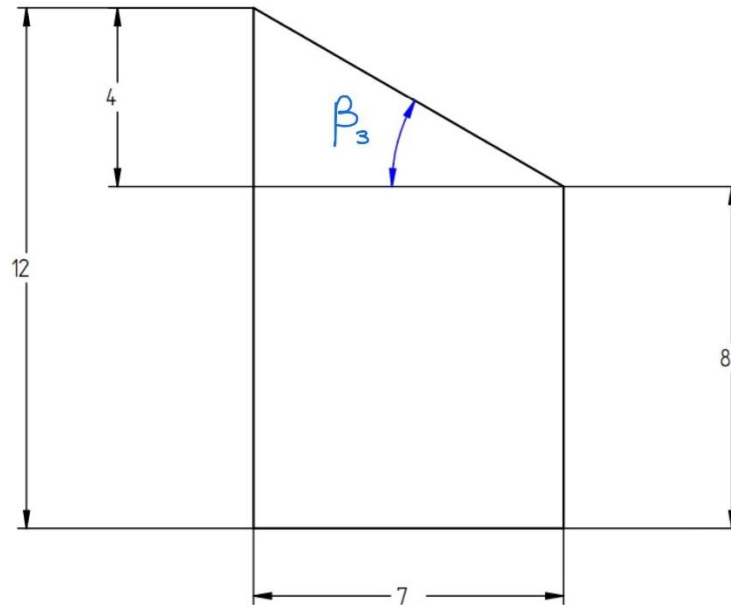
Tejado de la casa del ganadero donde se plantea instalar los paneles.
